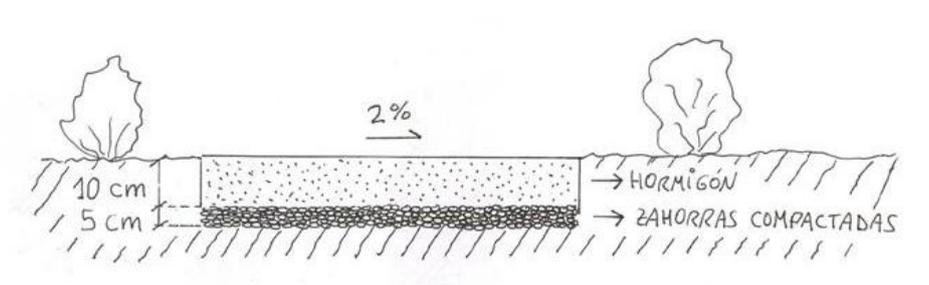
Sección tipo de camino ejecutado en hormigón.
